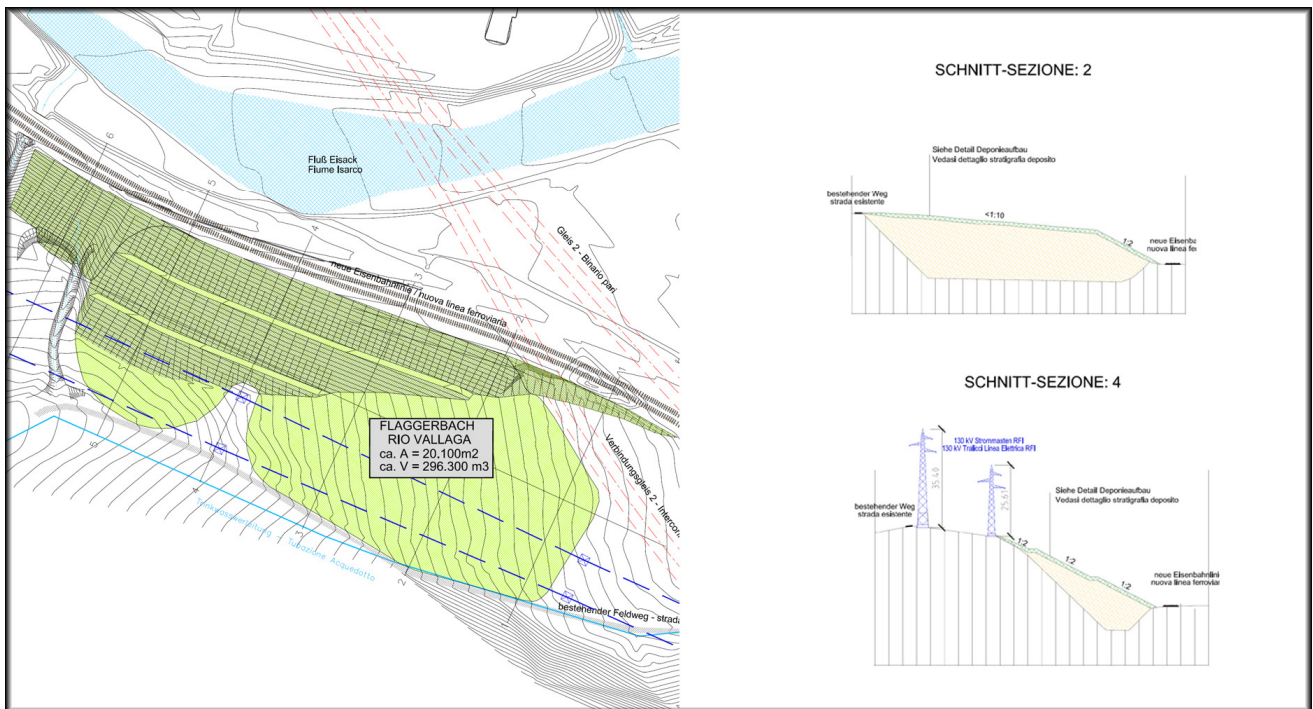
Lageplan und regelquerschnitt deponie Flaggerbach
